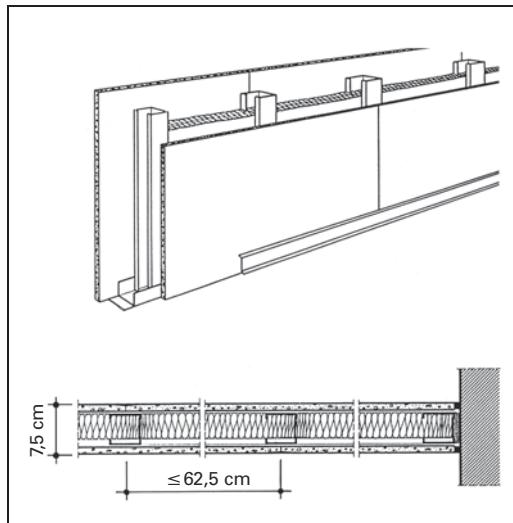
Metallständerwand Einfachständerwerk, einfach beplankt
